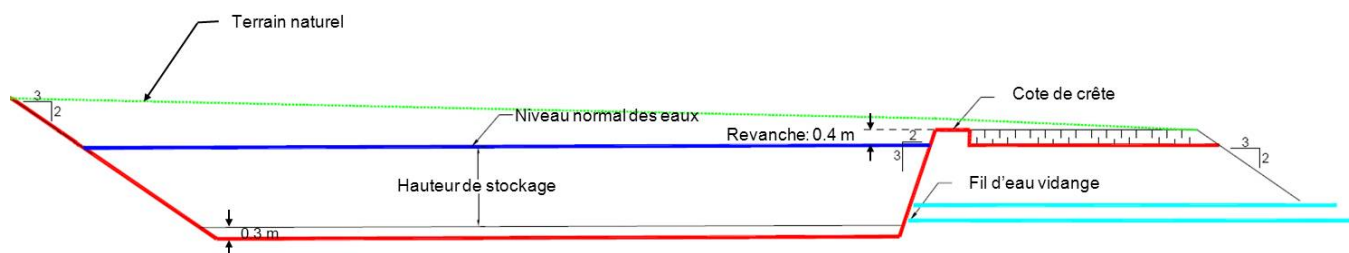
Coupe-type d'un barrage de fermeture de bassin
